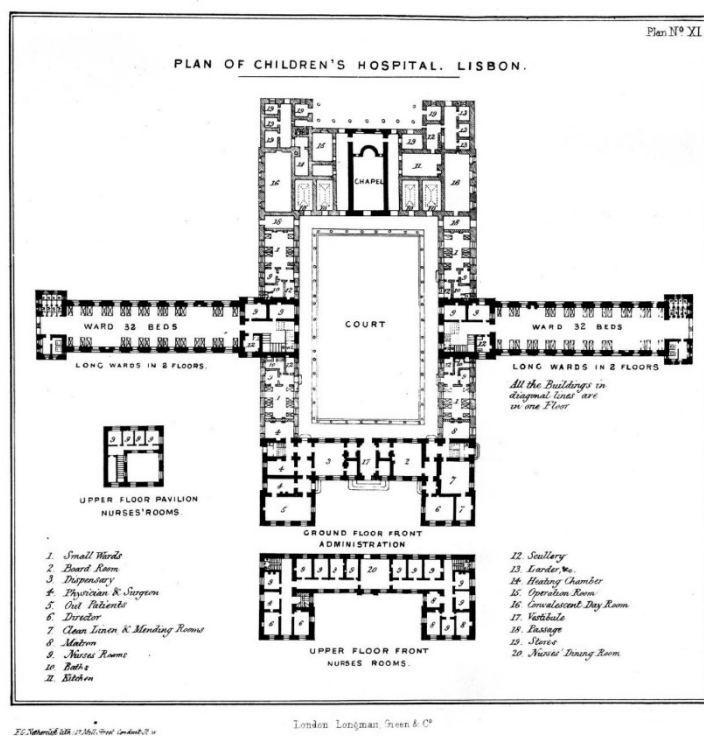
Planta de “Lisboa Hospital” (Nightingale, 1863, p.131) .
